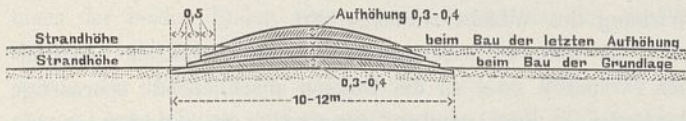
Packwerk in Grundlage und mit drei Aufhöhen.
